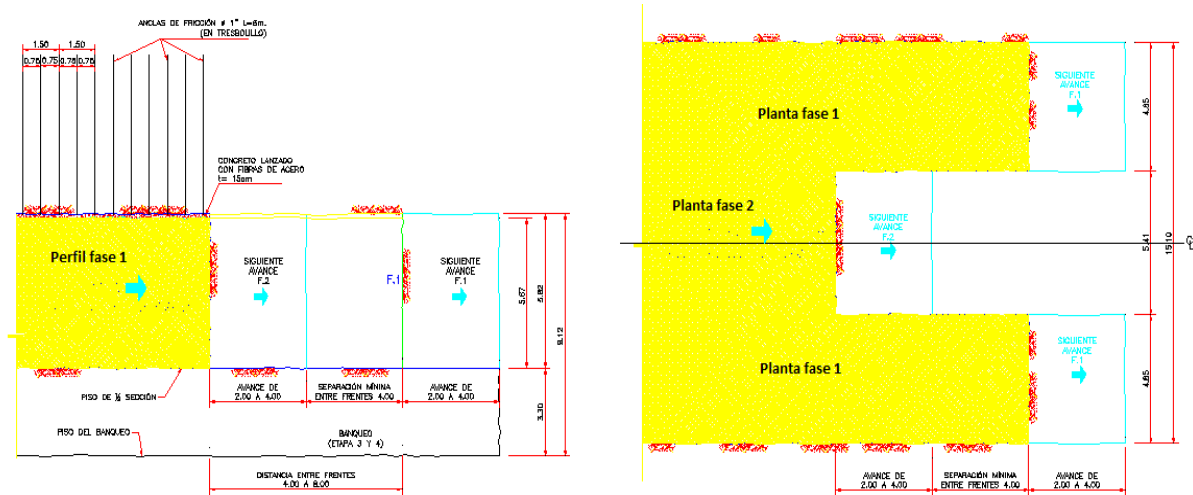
Perfil y planta del avance de la excavación en Condición Geotécnica “C⁽⁻⁾”
